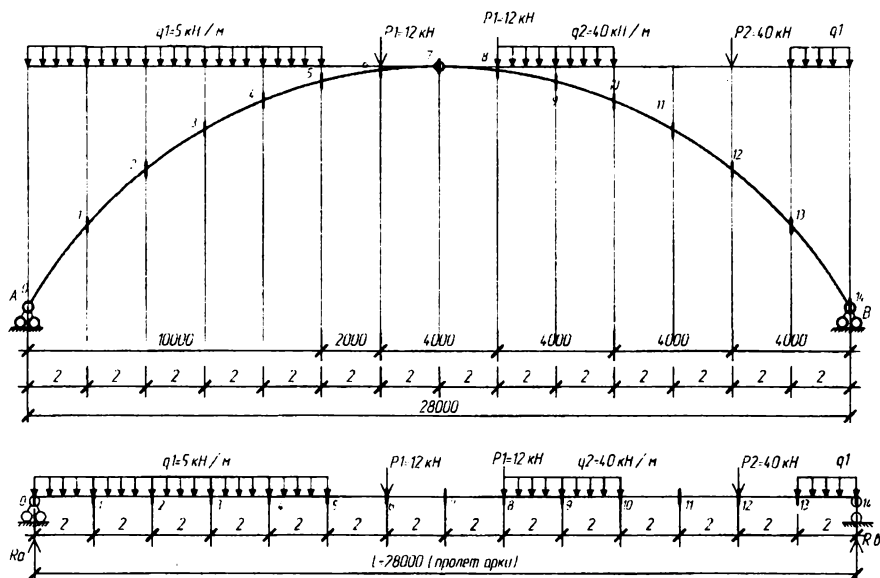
Расчетная схема арки и схема балки, для определения M_i^0 и Q_i^0
